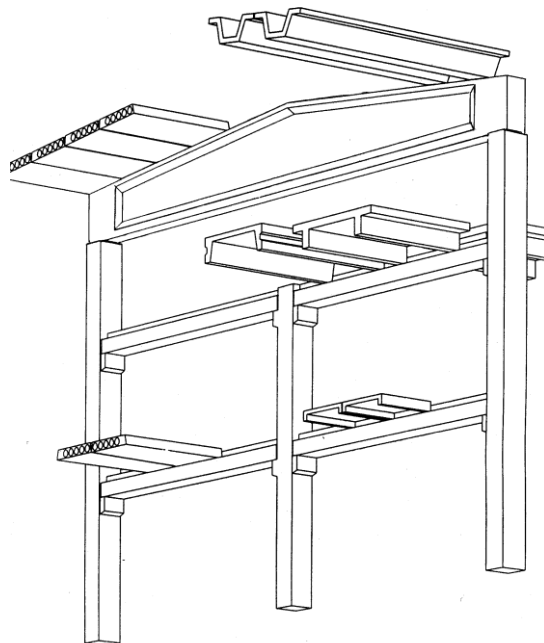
Planchers et toitures préfabriqués à grandes portées dans les bâtiments utilitaires
